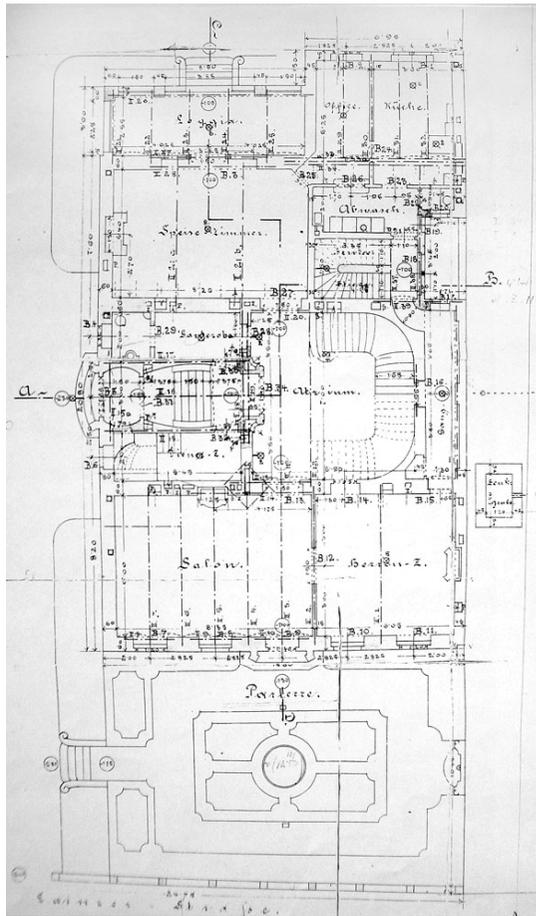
(links): Villa Geitler. Parterre-Grundriss und Gartenplan. 1894. Einreichplan.
